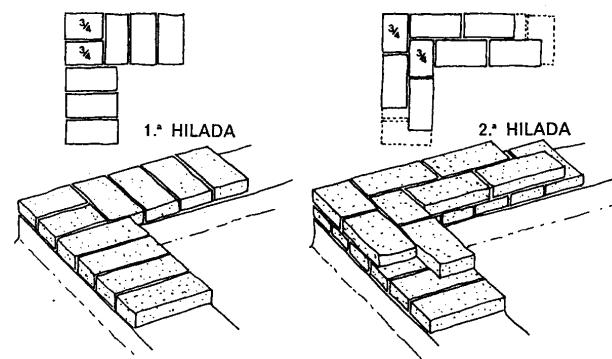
Encuentro de muro en "L" con ladrillos opuestos.
